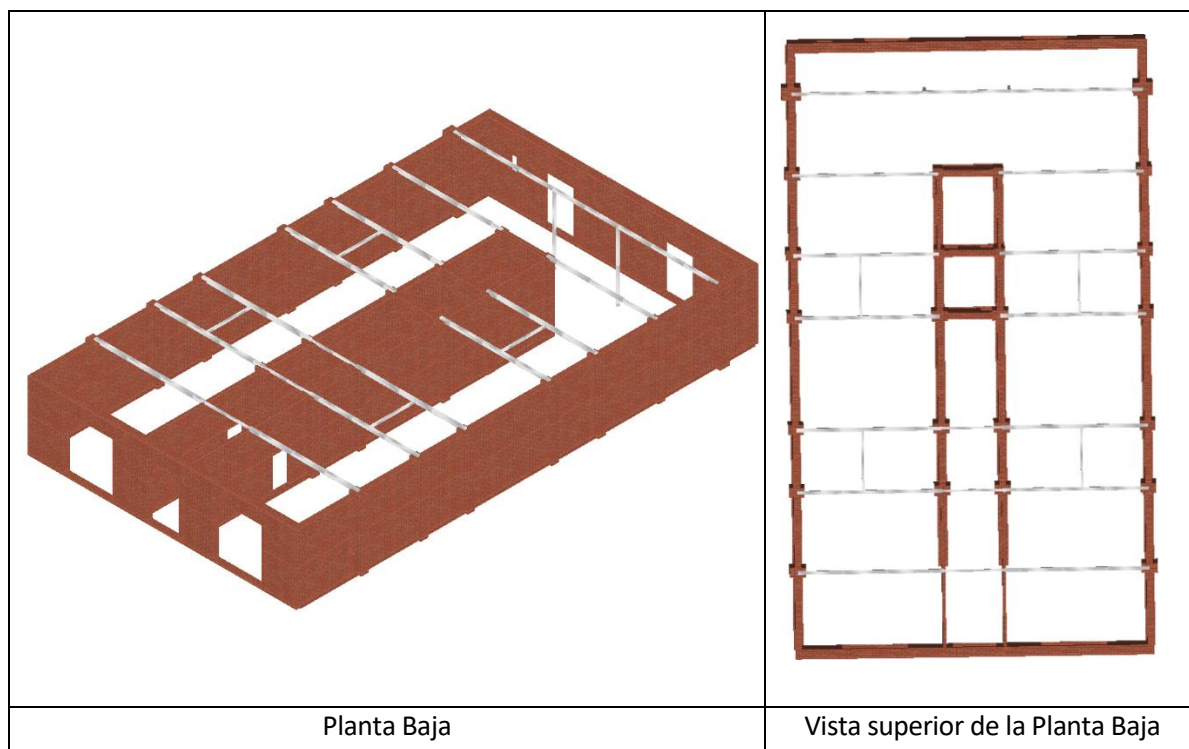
Modelo de Planta Baja (Fuente: Propia)
